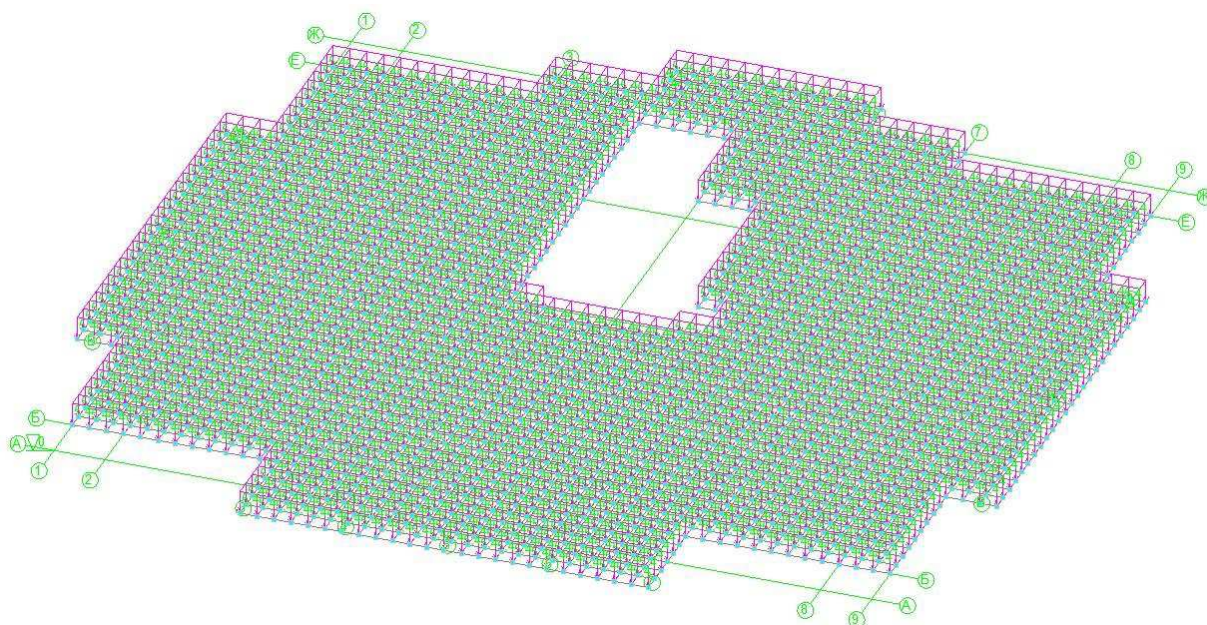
Схема загрузки плиты нагрузкой от собственного веса
